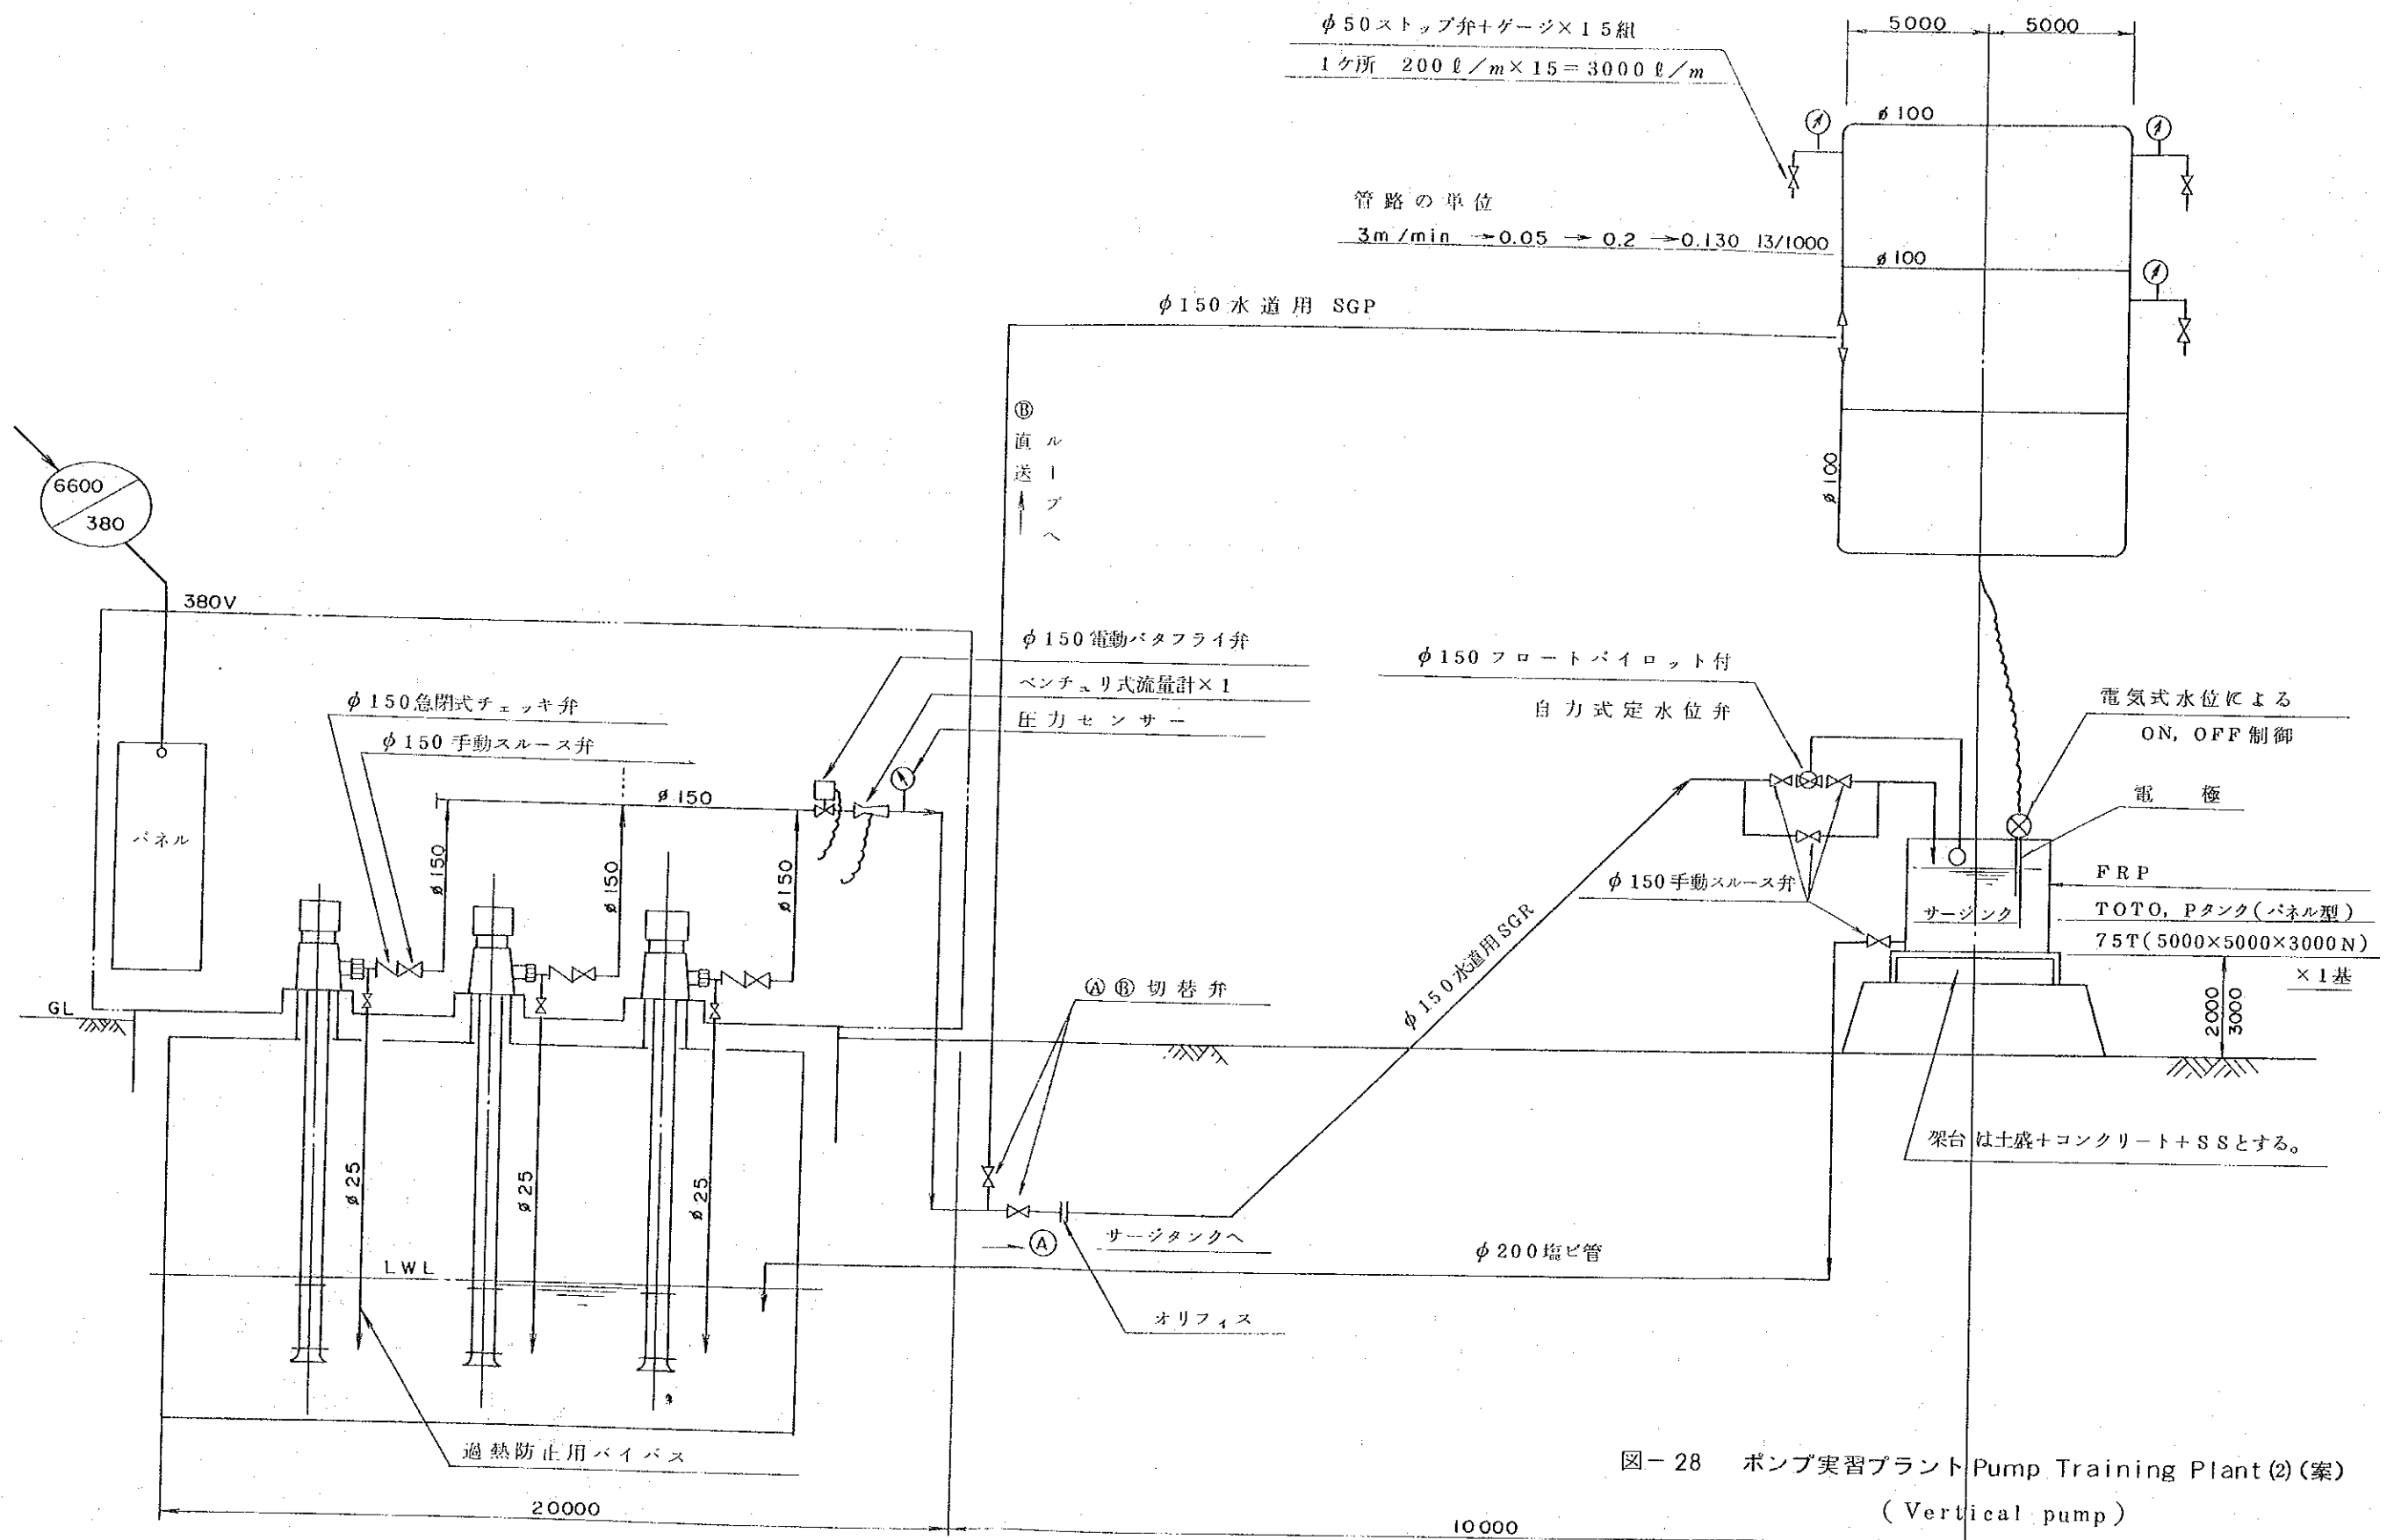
ポンプ実習プラント Pump Training Plant (2) (案)
